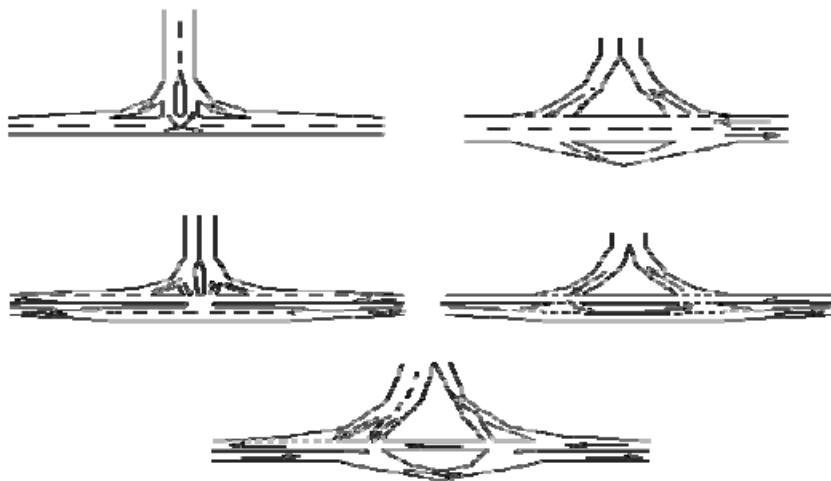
b. INTERSECCIONES TIPO “Y”.
